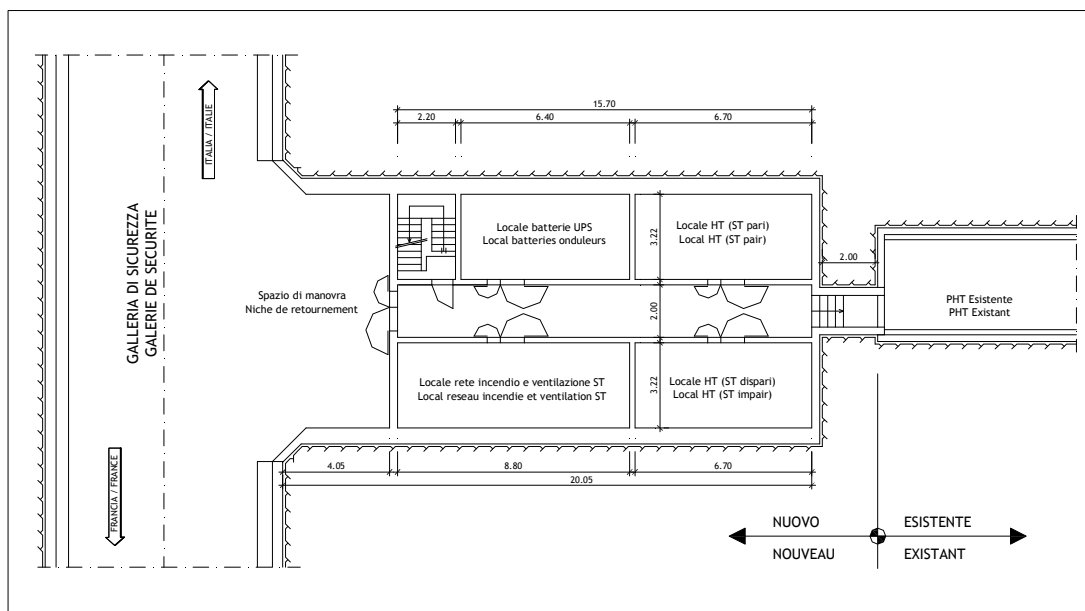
Station technique type - Vue en plan rez-de-chaussée
